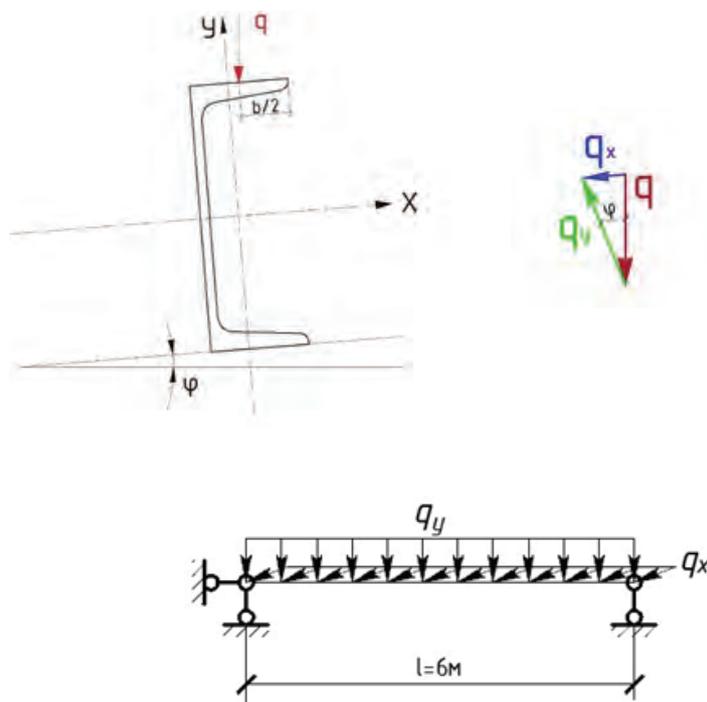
Поперечное сечение и расчетная схема прогона покрытия
